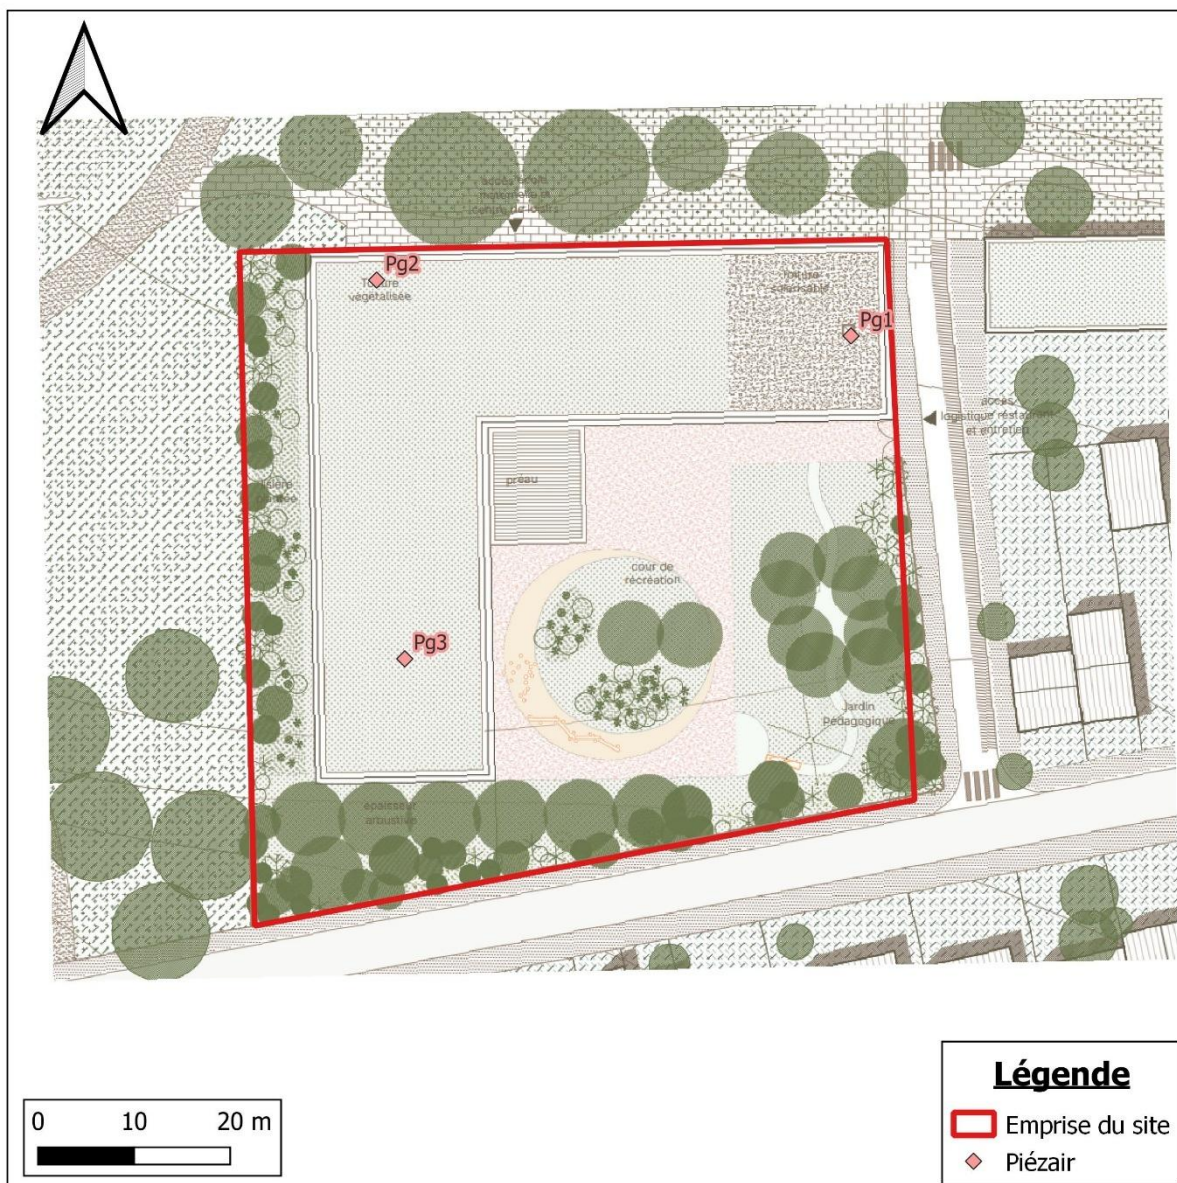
Plan d'implantation des piézairs vis-à-vis du projet
